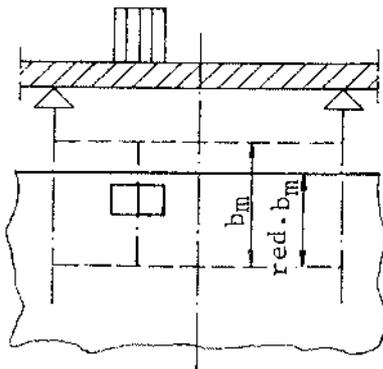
Ancho colaborante reducido de cargas cercanas al borde.
